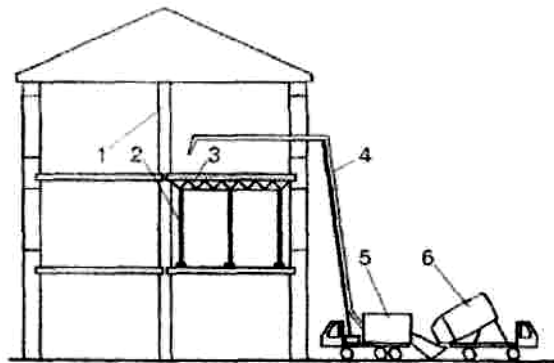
Подача бетонної суміші за допомогою автобетононасоса:
